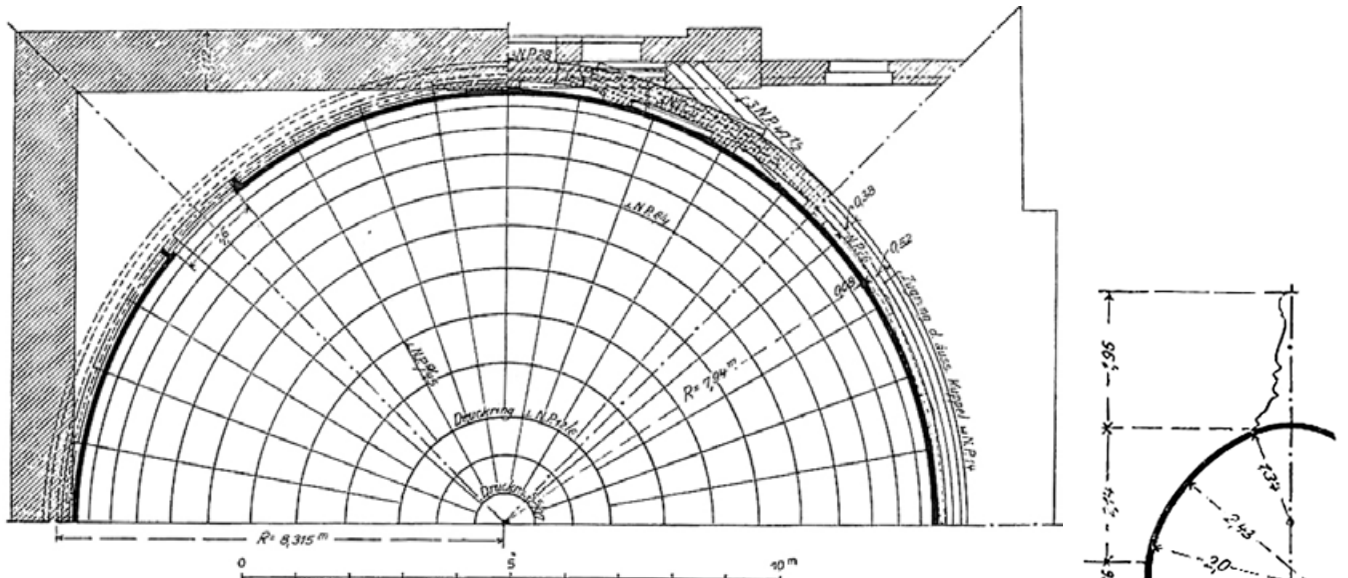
Armeemuseum: Grundriss der Kuppelkonstruktion (Mörsch 1912, S. 454).
